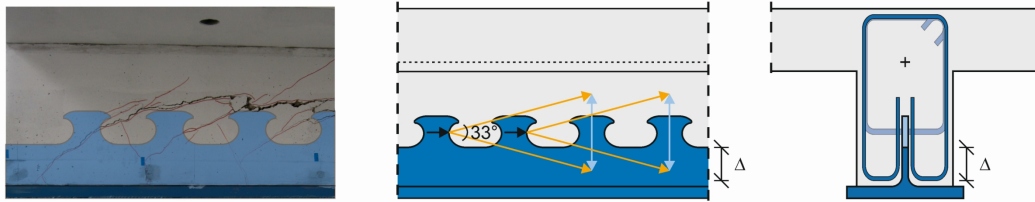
Vertikales Spalten bei Verbundträgern mit externer Bewehrung [FKP16]
